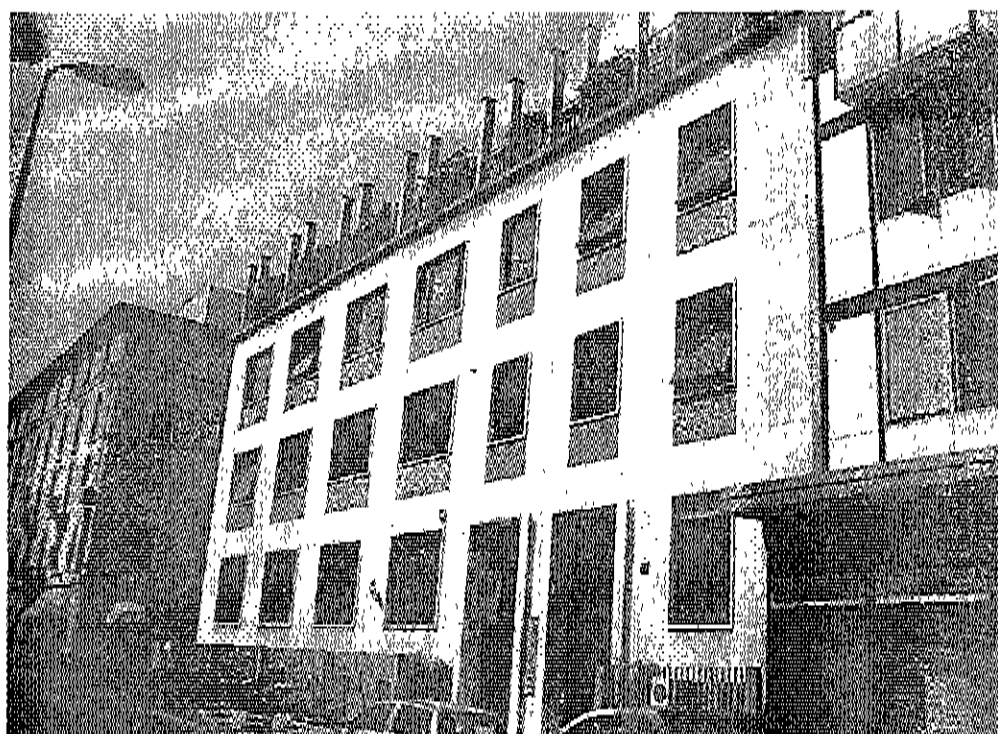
Prospetto principale dell'edificio - Via Casati, 16.
